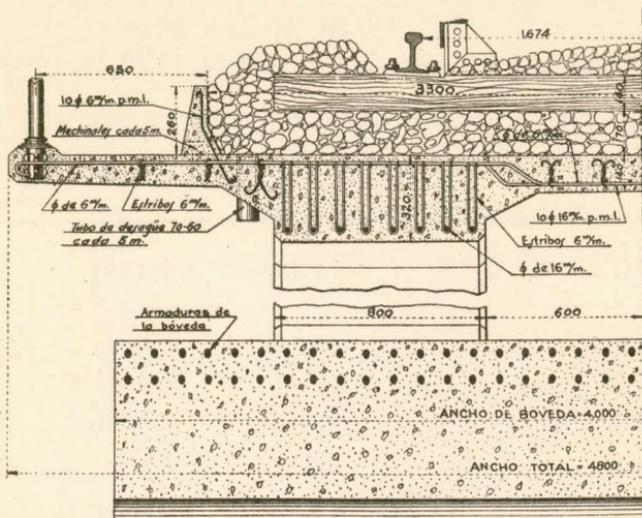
Arcos de hormigón en masa rebajados al  $1/4$ .
